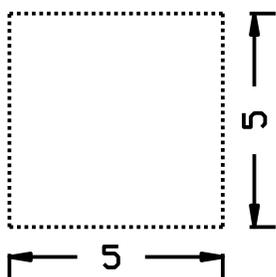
通訊鐵塔底部平面示意圖 單位 (m)
